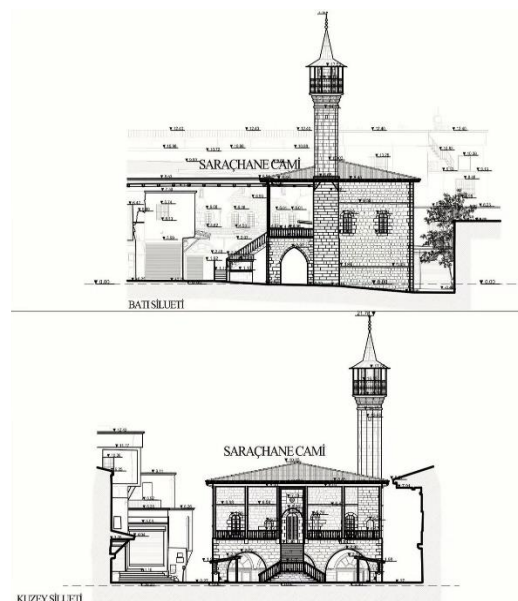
Mosquée Saraçhane : projections architecturales de reconstruction. @ZanMimarlık
